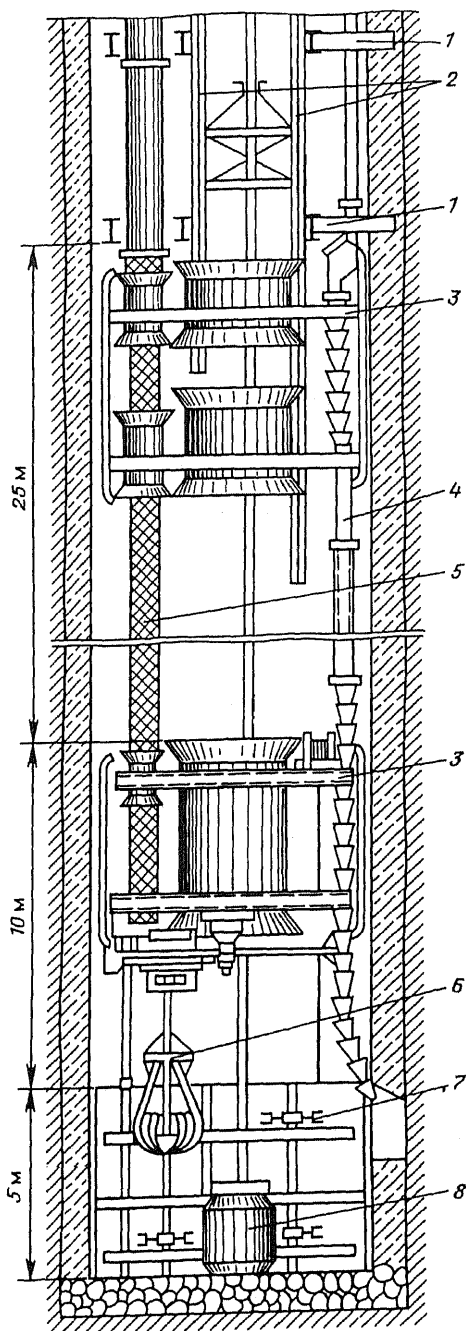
Схема армирования ствола одновременно с его проходкой: 1 — расстрелы; 2 — проводники; 3 — подвесные полки; 4 — бетонопровод; 5 — став вентиляционных труб; 6 — погрузочная машина; 7 — опалубка; 8 — бадья
